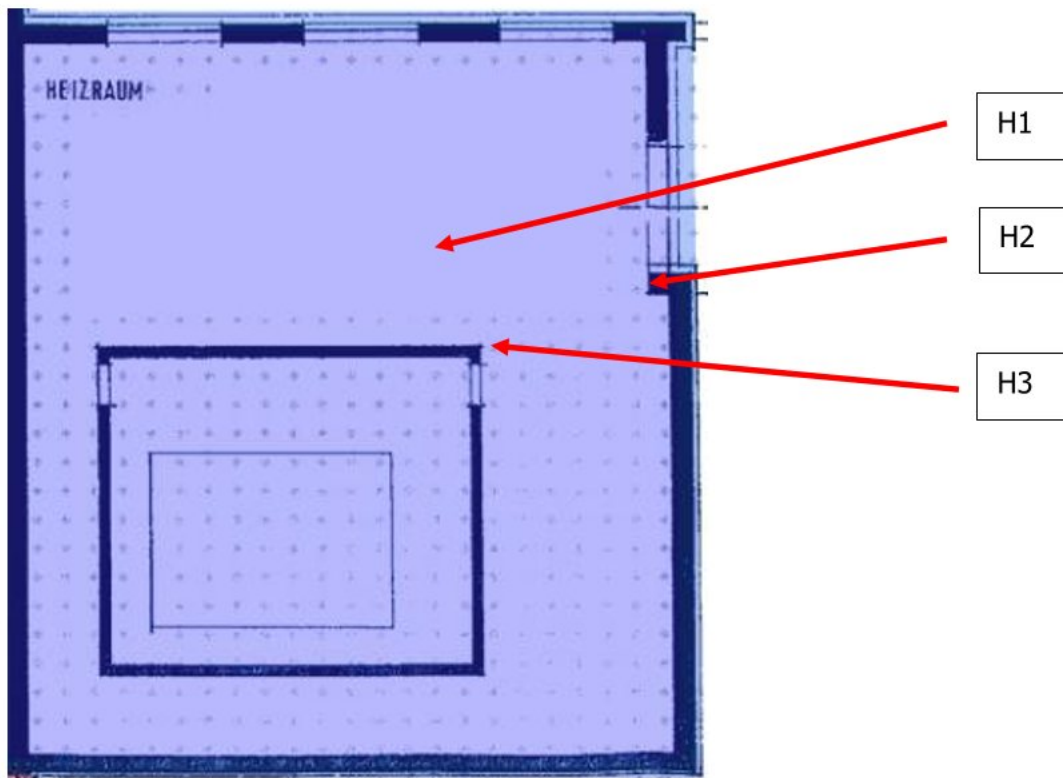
Teilbereich (siehe Grundriss).
